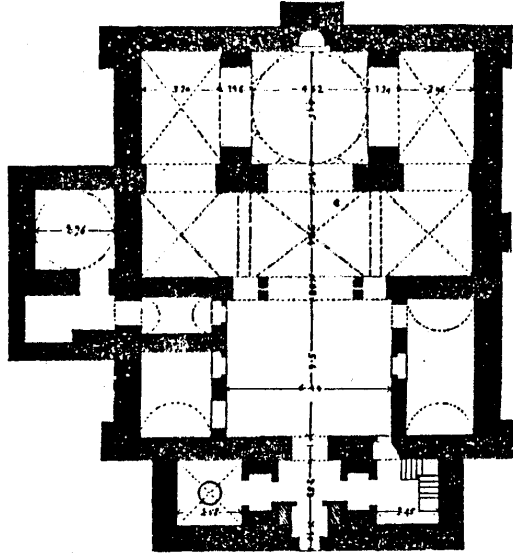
مسقط أفقي لجامع المؤيد شيخ بالقاهرة (عن لجنة حفظ الآثار العربية) .
